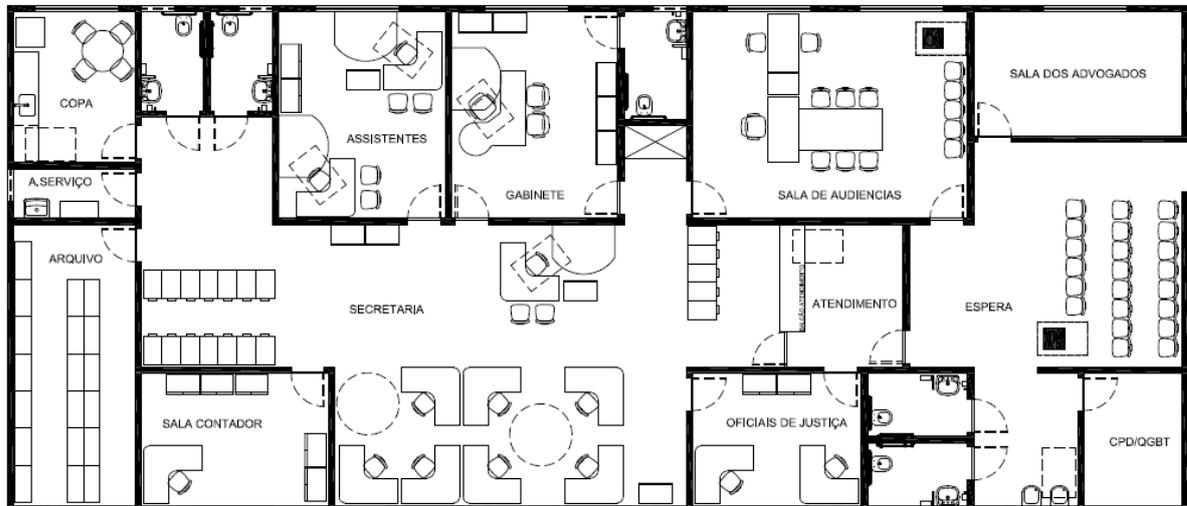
Planta Baixa Padrão de Vara do Trabalho
